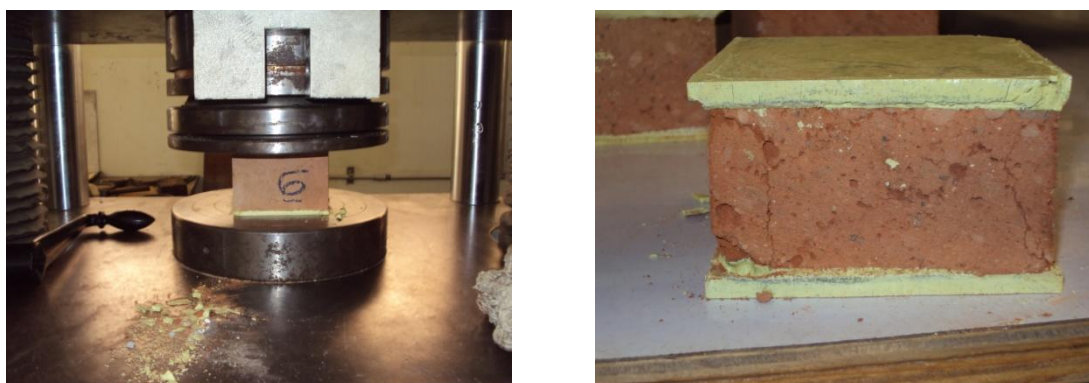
Especímen durante y después del ensayo a compresión.
